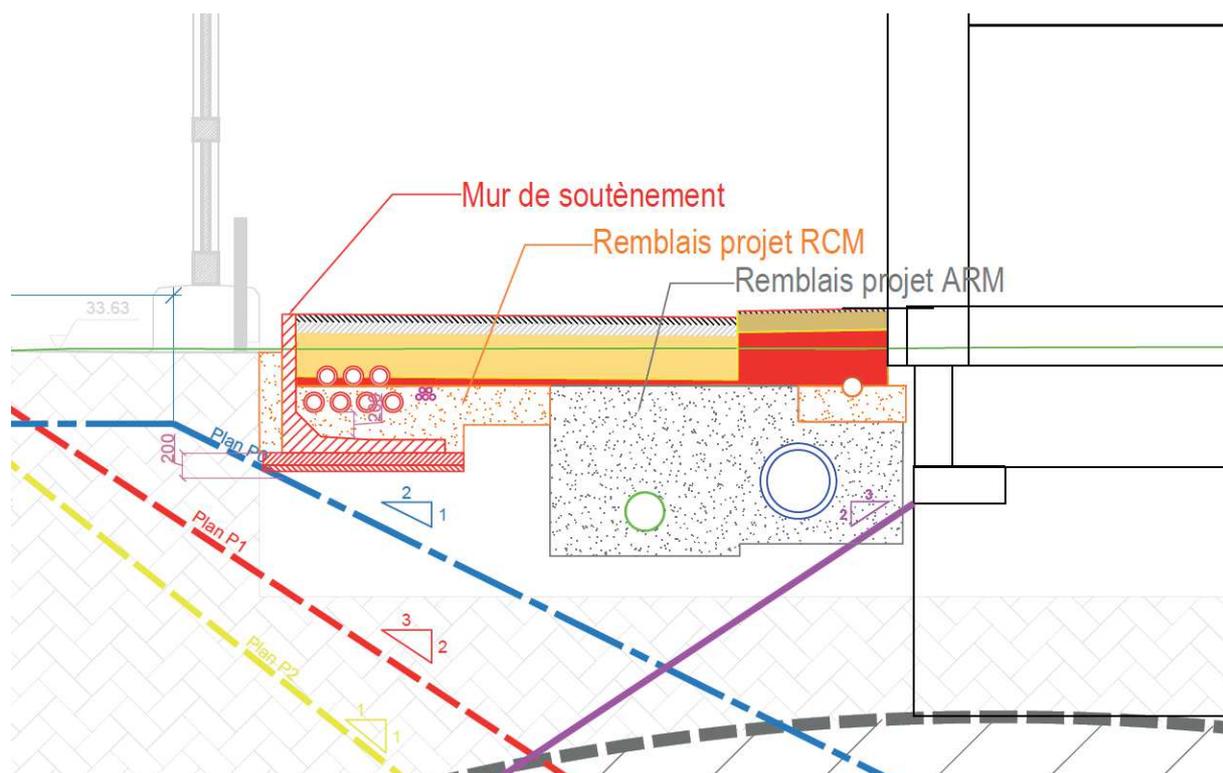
Coupe File 27 Architecte – Habillage avec réseaux divers et mur de soutènement
